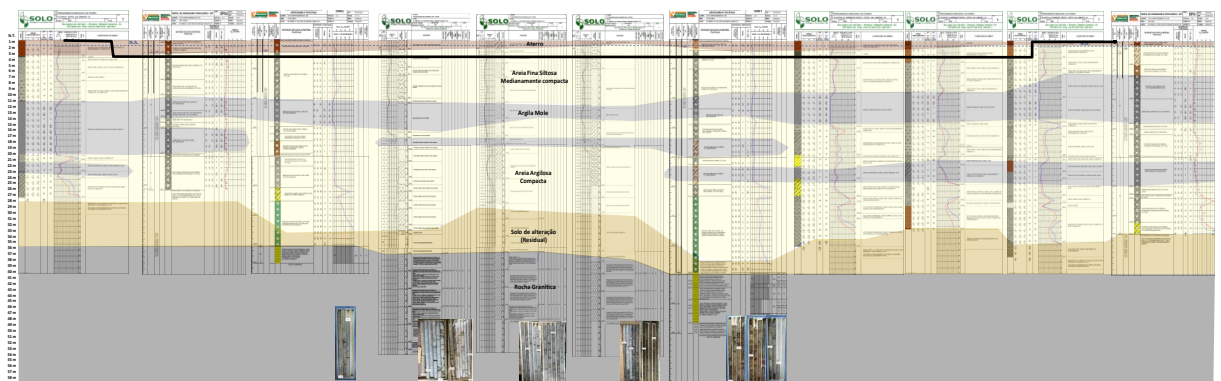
Desenho esquemático, da projeção em corte, da implantação do subsolo com o perfil geotécnico do terreno.
